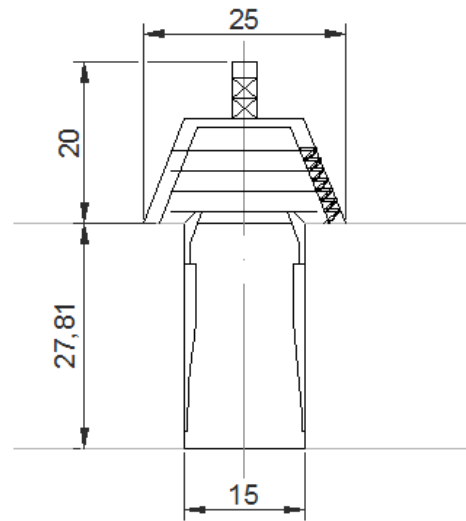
Medidas cuerpo estructural y superestructura de la torre, vista longitudinal (Fuente propia)
